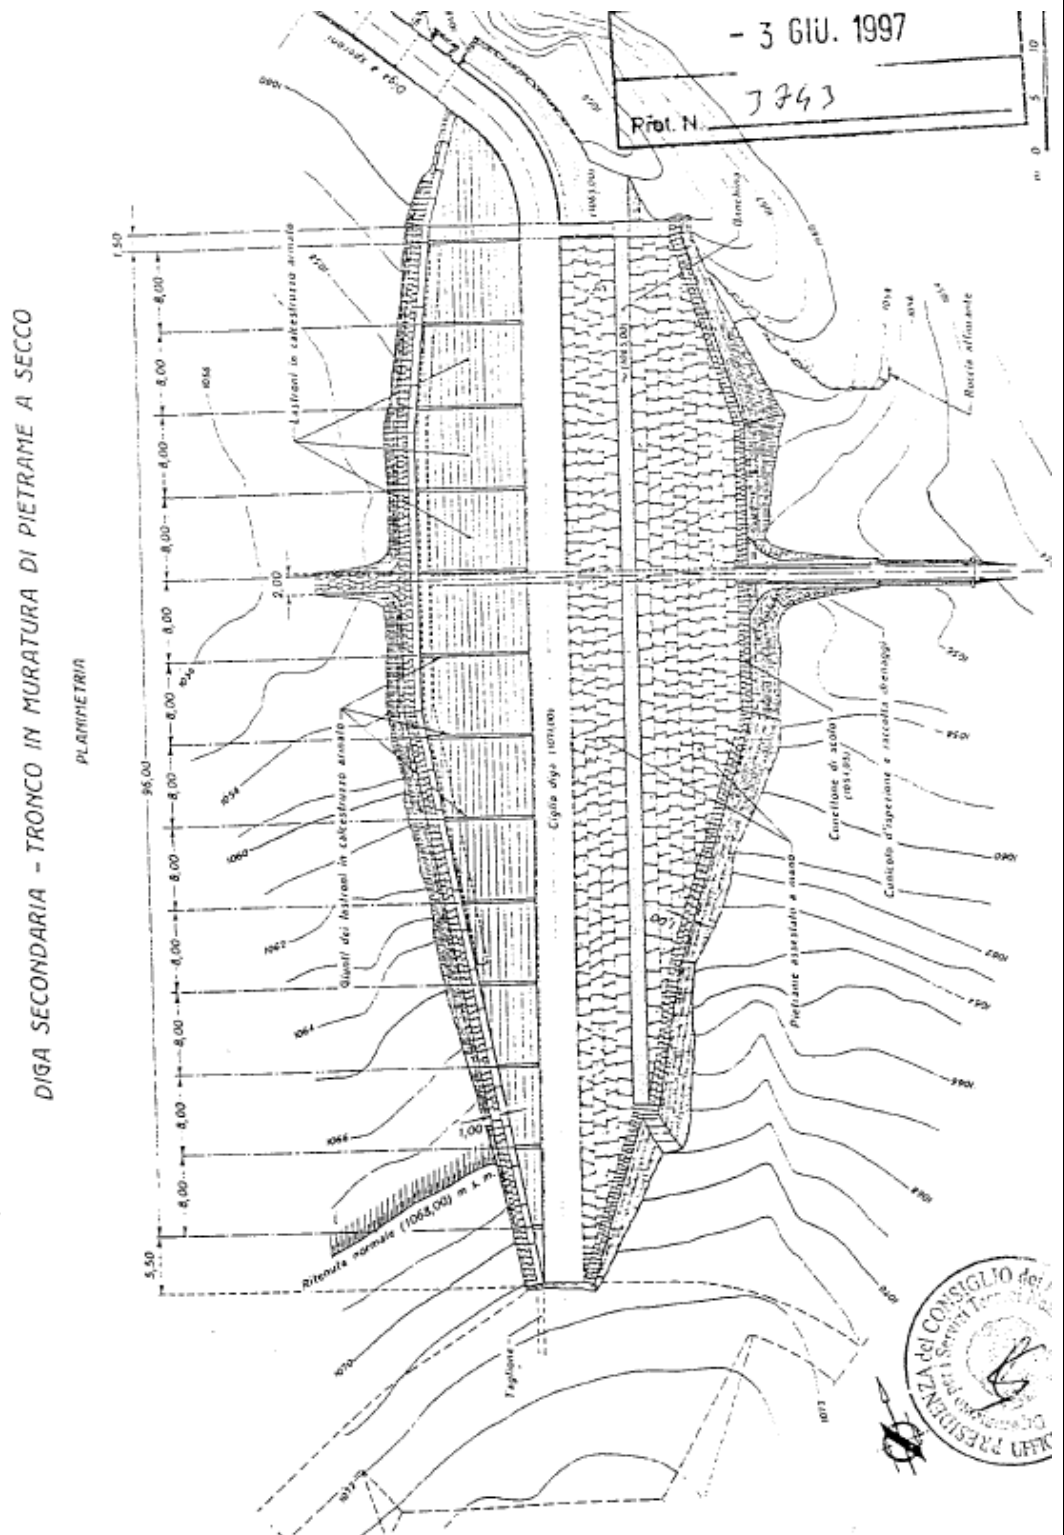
Invaso di Montagna Spaccata. Diga 3 in muratura di pietrame a secco. Planimetria
